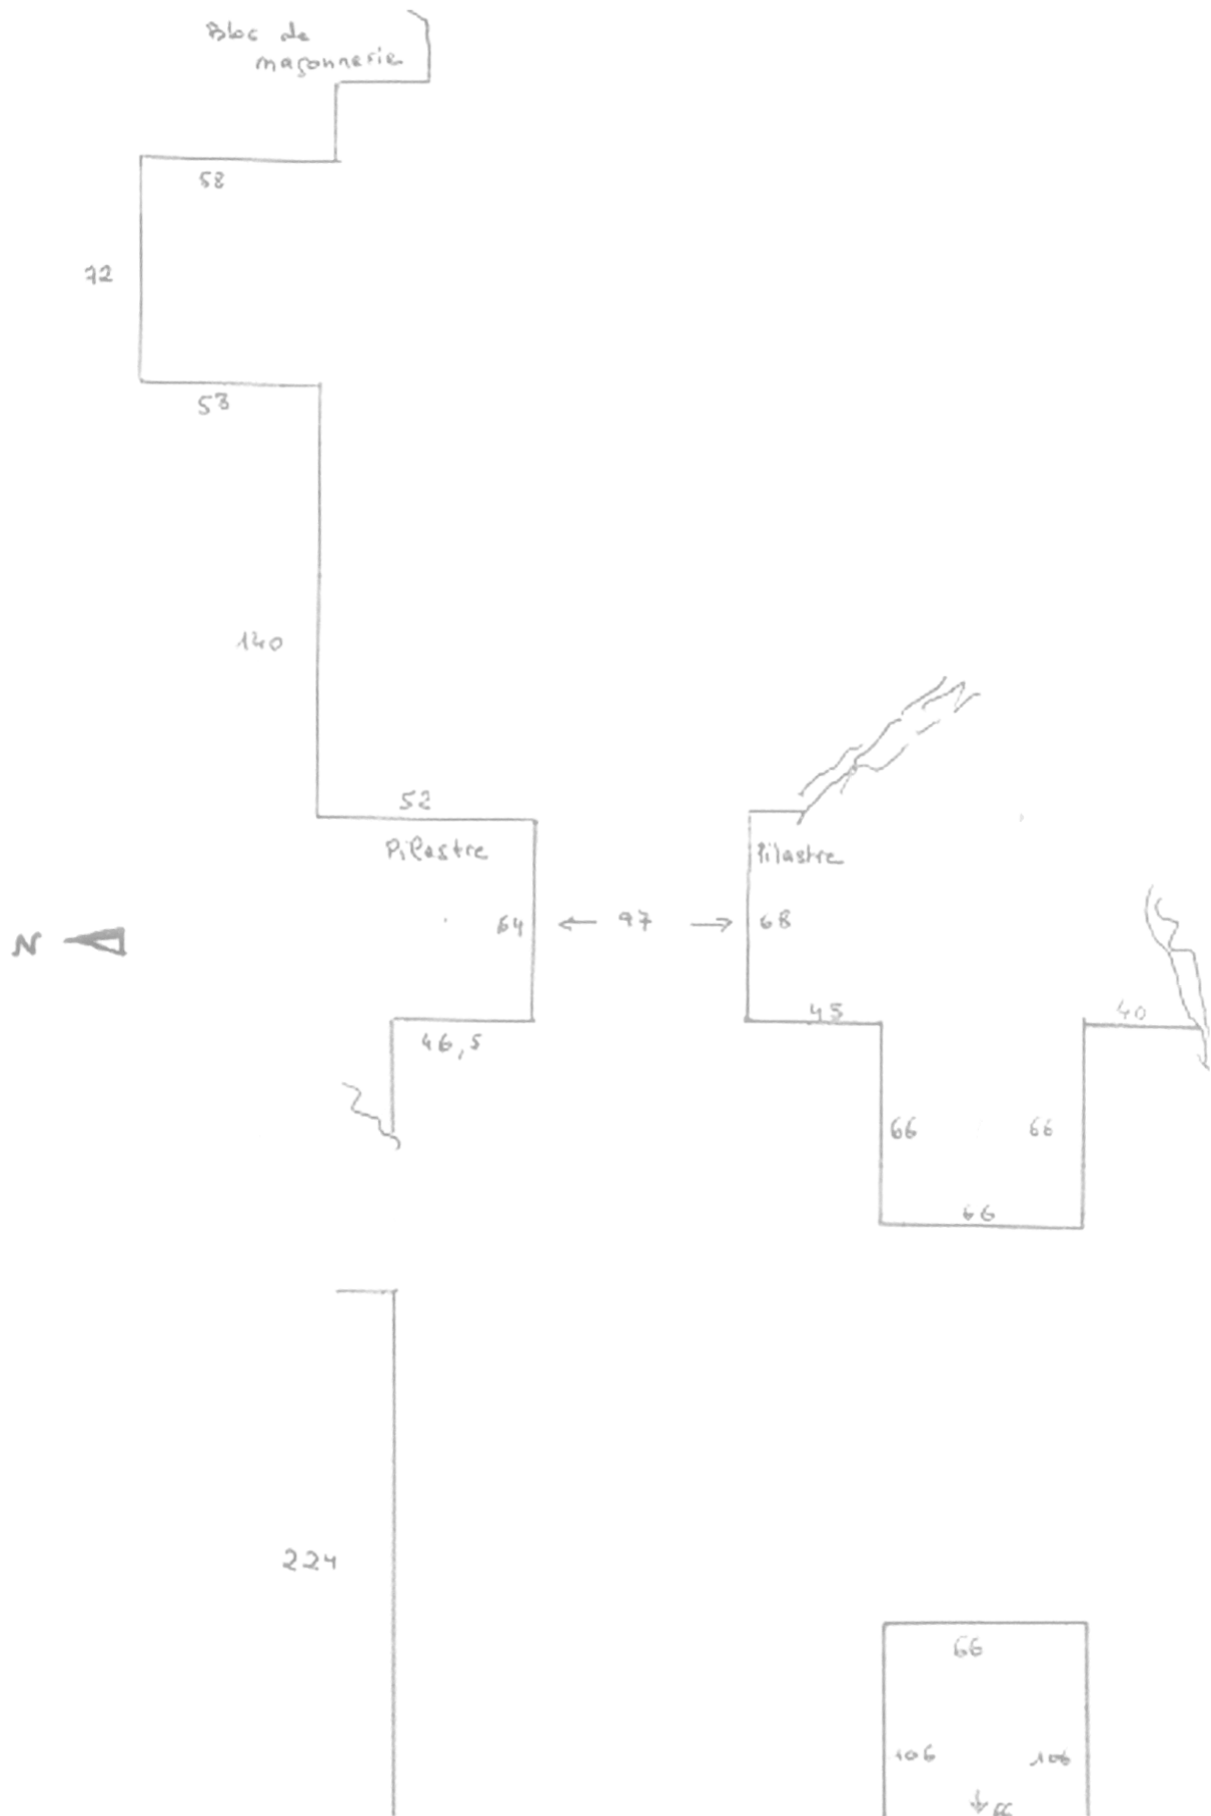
Kiliseyeri, plan des structures dégagées en 2007.
